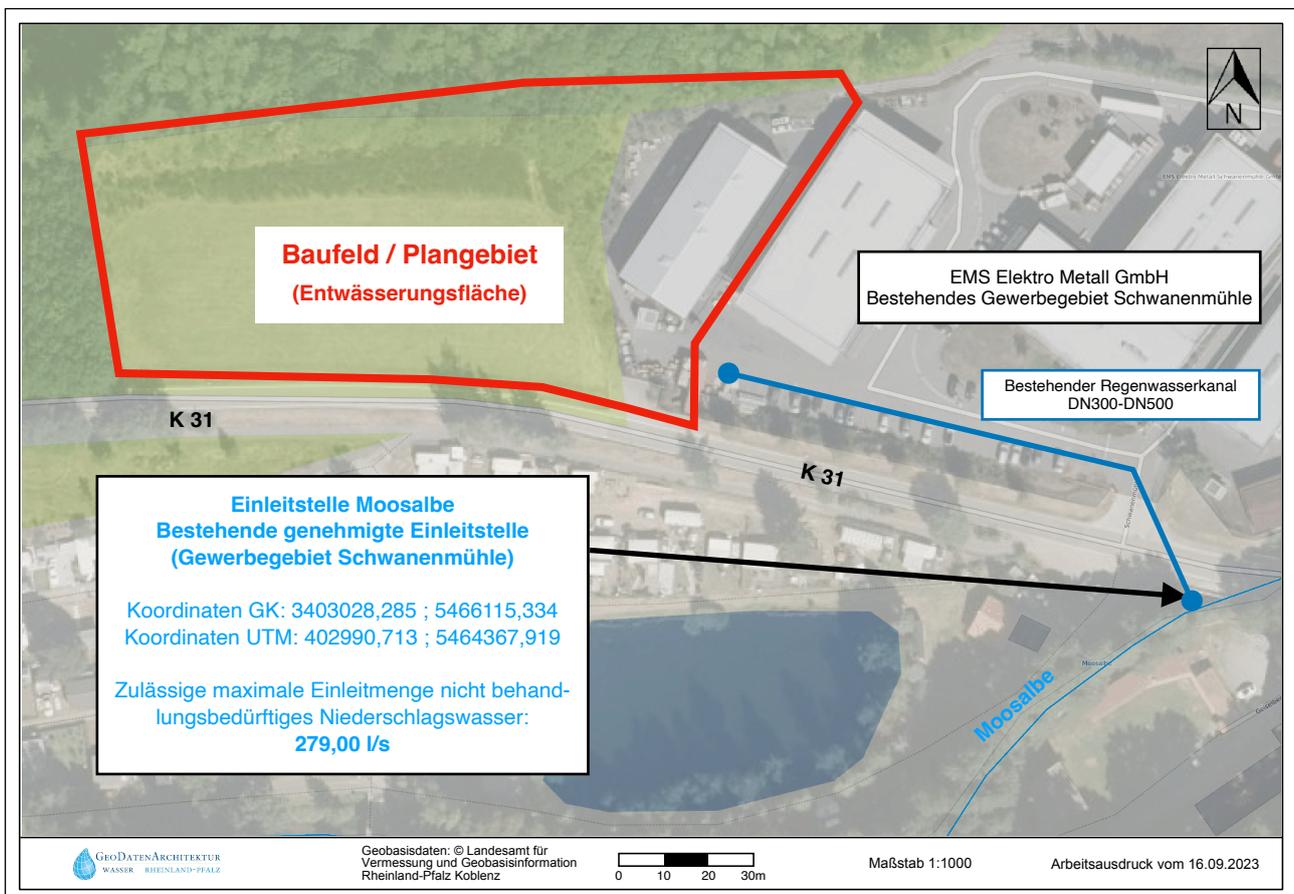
Geplantes Baugebiet und Anschluss an best. Trennsystem und gen. Einleitstelle (Bild Quelle: Landesamt für Vermessung)
